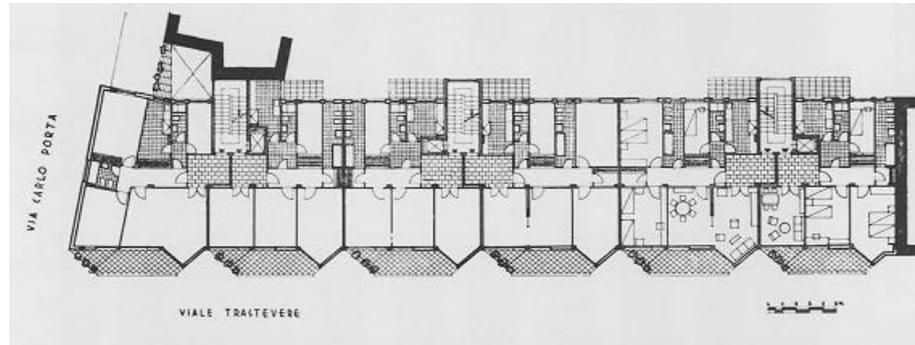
Planta edificio. (*Informes de la Construcción* Vol. 11, nº 103, agosto-septiembre de 1958)
